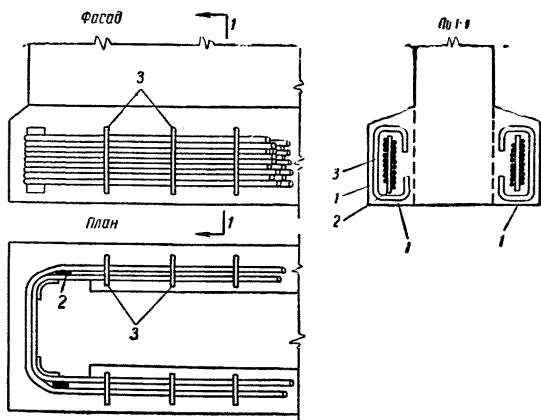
Конструктивное мероприятие, предохраняющее от возможного отслоения защитного слоя бетона
